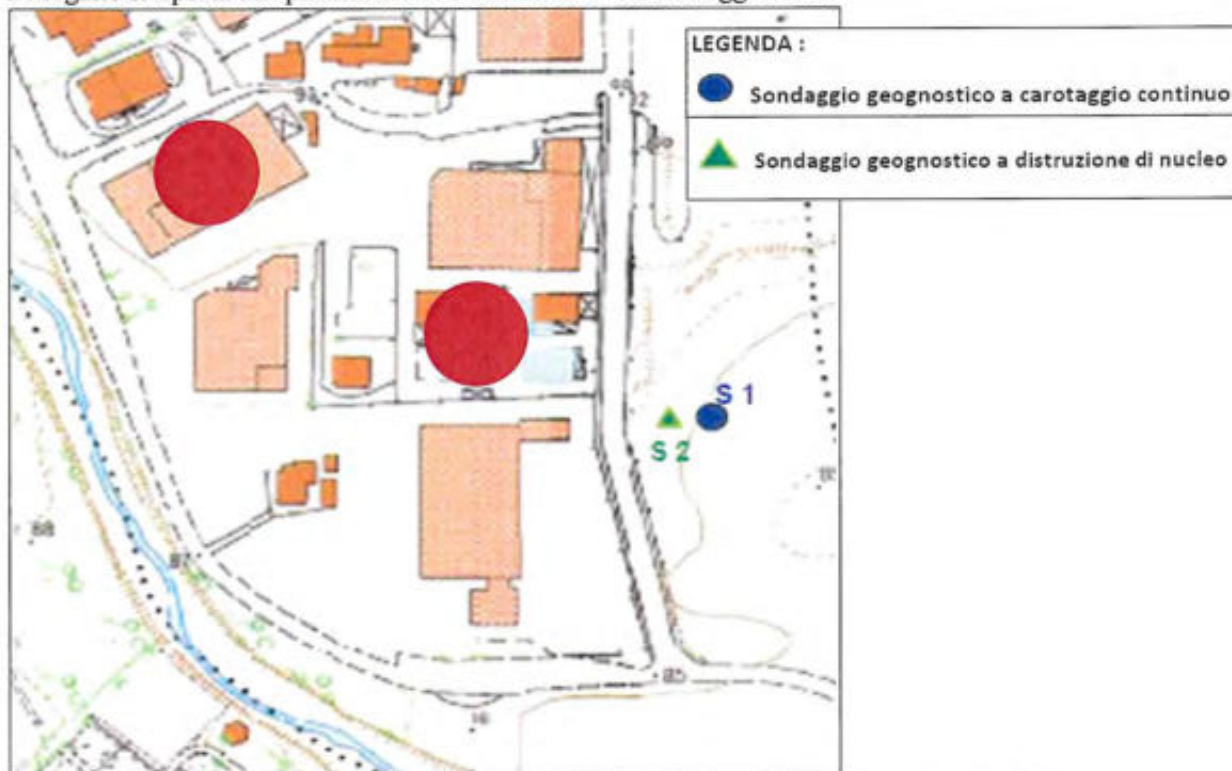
Planimetria sondaggi | in rosso gli edifici della Ditta (da integrazioni allo SIA)
